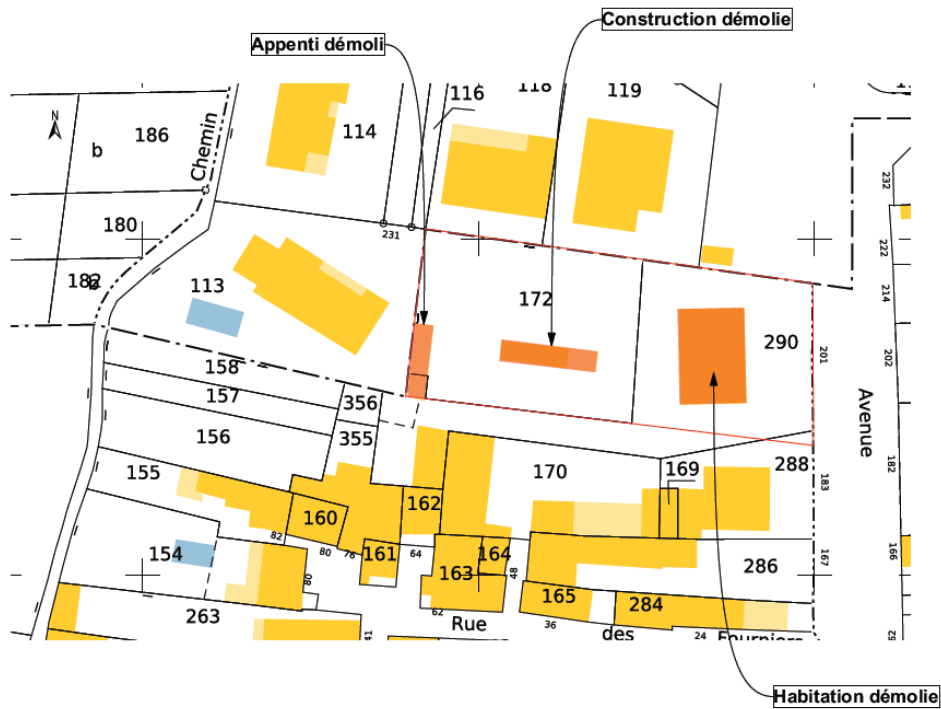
plan de démolition au droit des bâtiment 2 et 3 [8]
